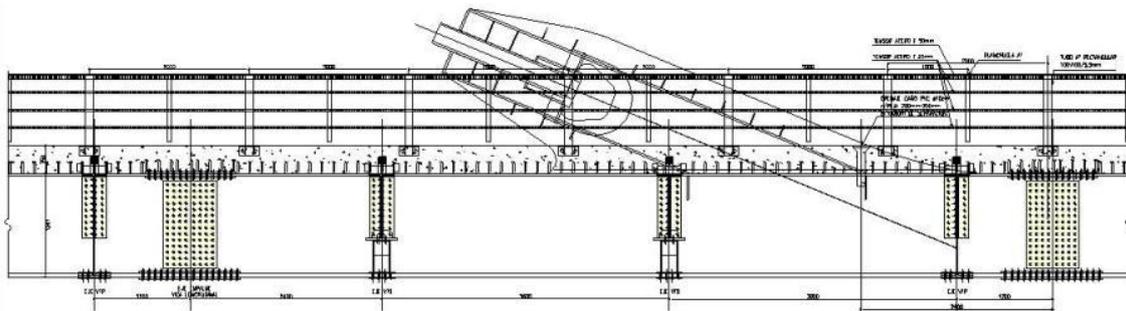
Anclaje del cable hacia el tablero Puesto Río Pastaza
